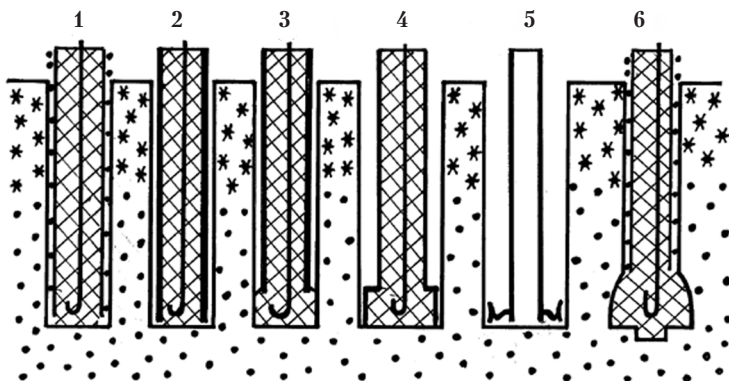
Некоторые типы фундаментных столбов глубокого заложения, монтируемых в заранее пробуренную скважину (вырытую яму, траншею, котлован). 1 – бетонный столб с арматурой, заливаемый непосредственно в скважине в опалубку-гильзу из свёрнутого в трубку рубероида (пергамина), обернутого проволокой (бечевкой), 2 – бетонный столб с арматурой, залитый непосредственно в скважине в асбоцементную или пластиковую трубу диаметром 100–250 мм, 3 – то же, что и в типе 2, но сразу же после заливки бетона трубу приподнимают на 10–15 см для формирования расширения внизу столба (якоря), 4 – заранее изготовленный железобетонный столб с расширением внизу, опускаемый в скважину, 5 – металлический столб, заранее изготовленный из трубы диаметром 50–120 мм с приваренным подпятником (например, ободом автомобильного колеса), 6 – бетонный столб с арматурой, заливаемый непосредственно в скважину с расширением, пробуренную буром конструкции Яковлева (технология ТИСЭ), в гильзу-опалубку из свёрнутого в трубку рубероида. Зазоры между столбом и грунтом засыпаются песком и проливаются водой.
